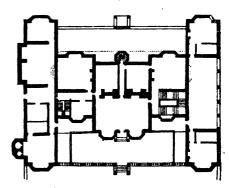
Grundriß des Holland Houfe in Renfington. Rach R. Blomfielb, "A history of Renaissance Architecture in England". London 1897.
